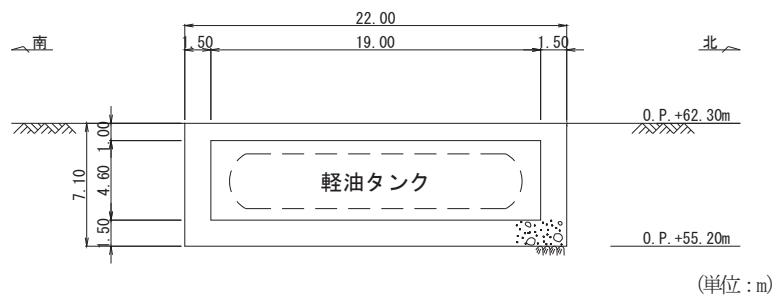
ガスタービン発電設備軽油タンク室断面図 (A-A)
